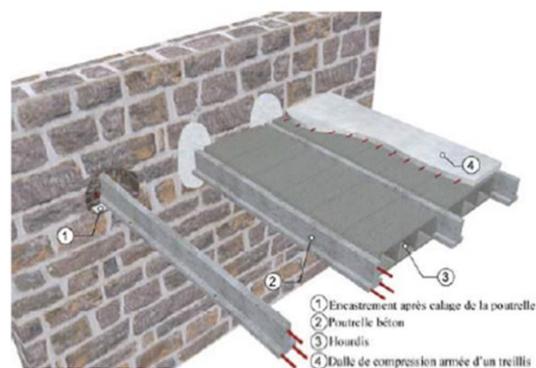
plancher à poutrelles en béton armé encastré dans le mur.
